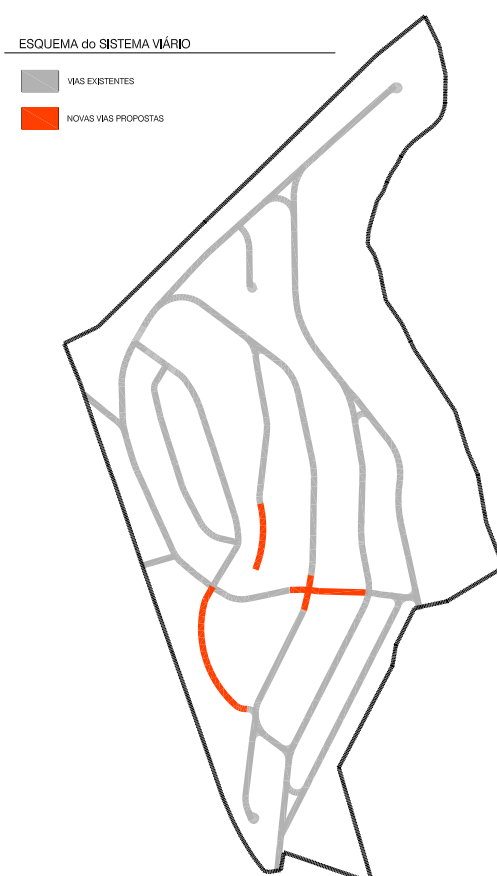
Planta de Sistema Viário e Estacionamento do Plano de Pormenor do Espartal (extrato)
